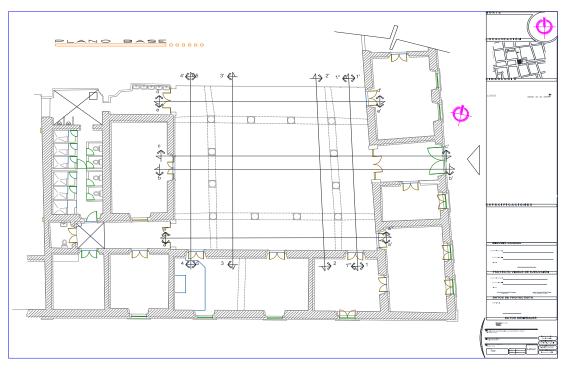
Plano Levantamiento topográfico, (planta estado actual). Eloísa Galván González. 2016.
